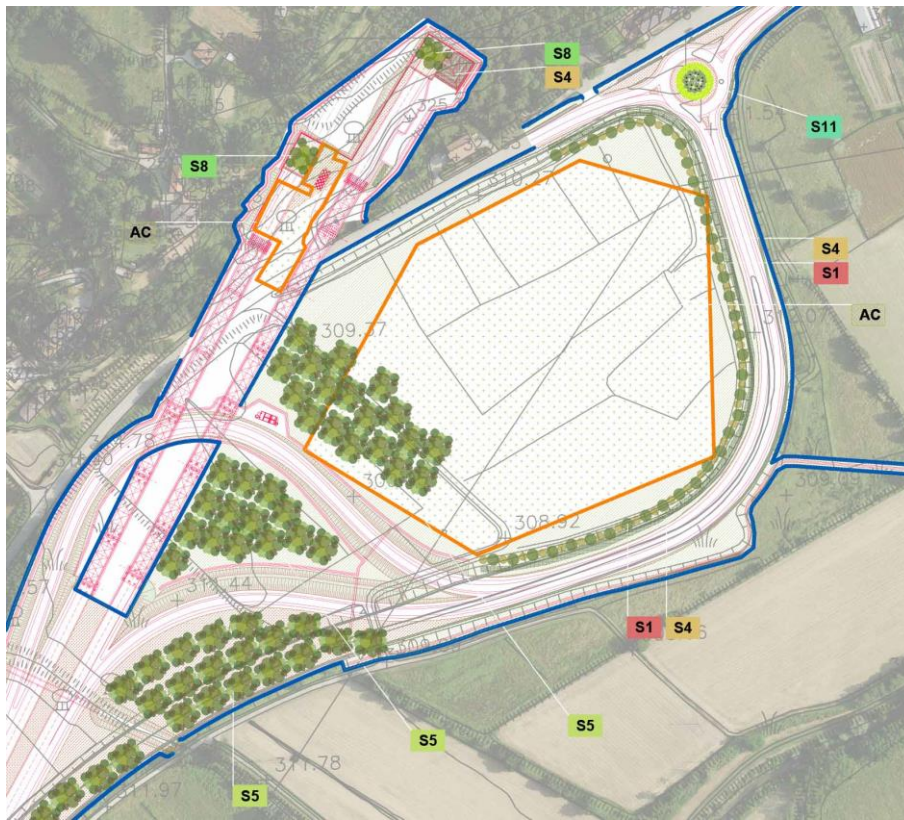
Stralcio della planimetria con area di cantiere in prossimità dello svincolo Le Ville
